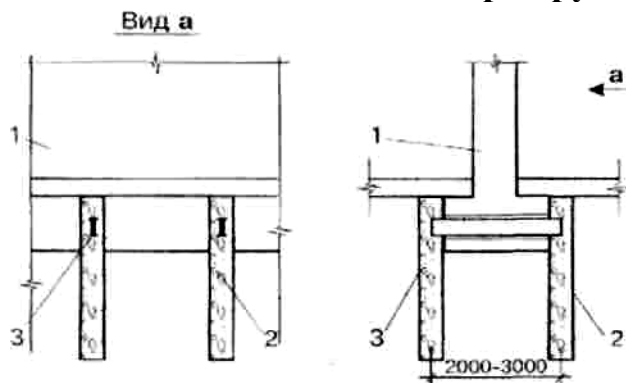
Схема підсилення фундаментів винесенням навантажень за їх межі:
